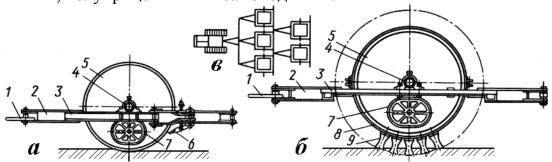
Прицепные катки с металлическими вальцами: a – с гладким; δ – с кулачковым; ϵ – схема соединения катков для работы в сцепе
